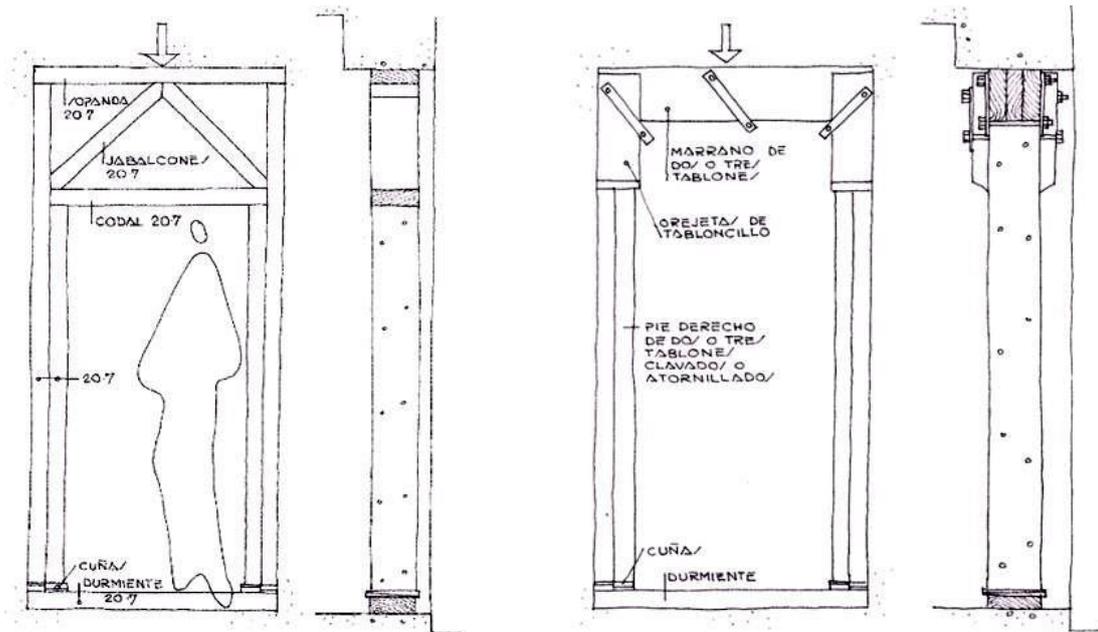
Recercado de hueco de puerta con jabalcoes simples (izda.) y con puente en dintel (dcha.).
